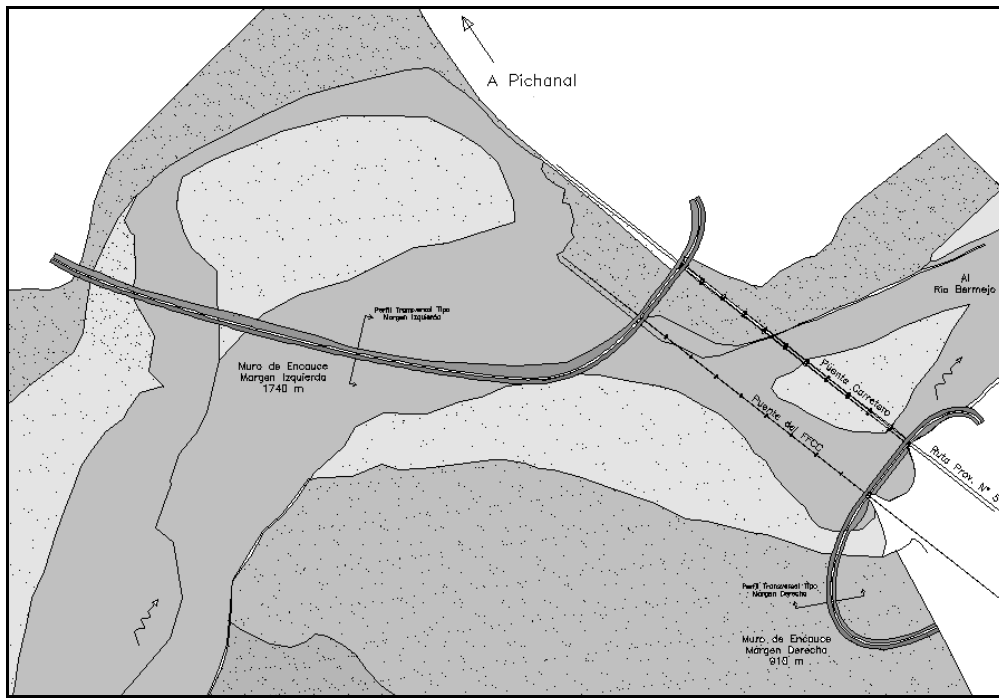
Disposición esquemática en planta de los muros de encauzamiento.
